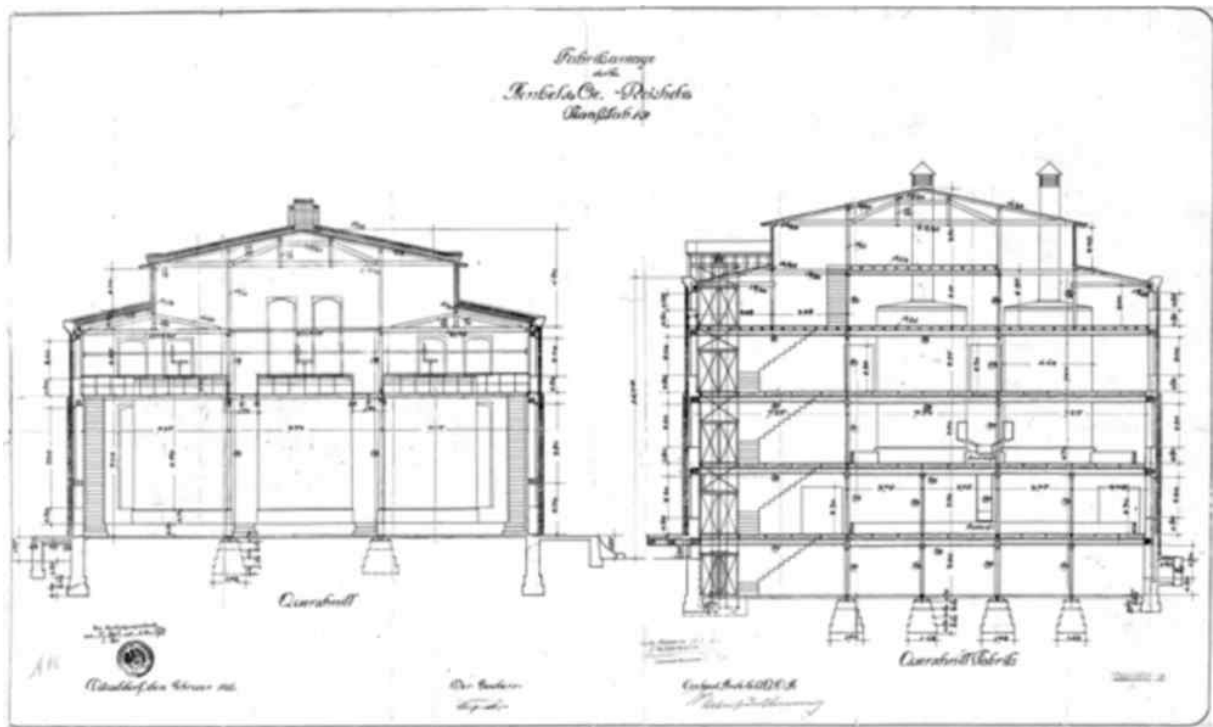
Neubau Seifenpulver-Fabrikgebäude Geb. C 02, 1911 - Architekt: Walter Furthmann
